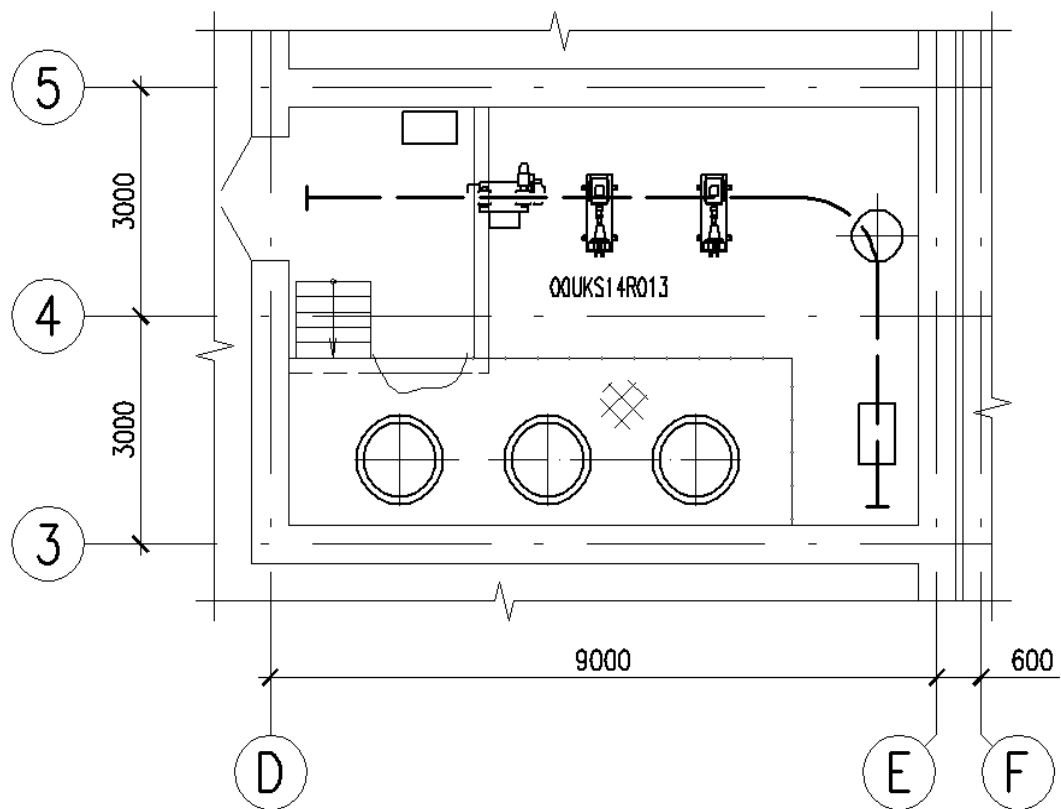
Габаритные размеры помещения приготовления щелочного раствора
